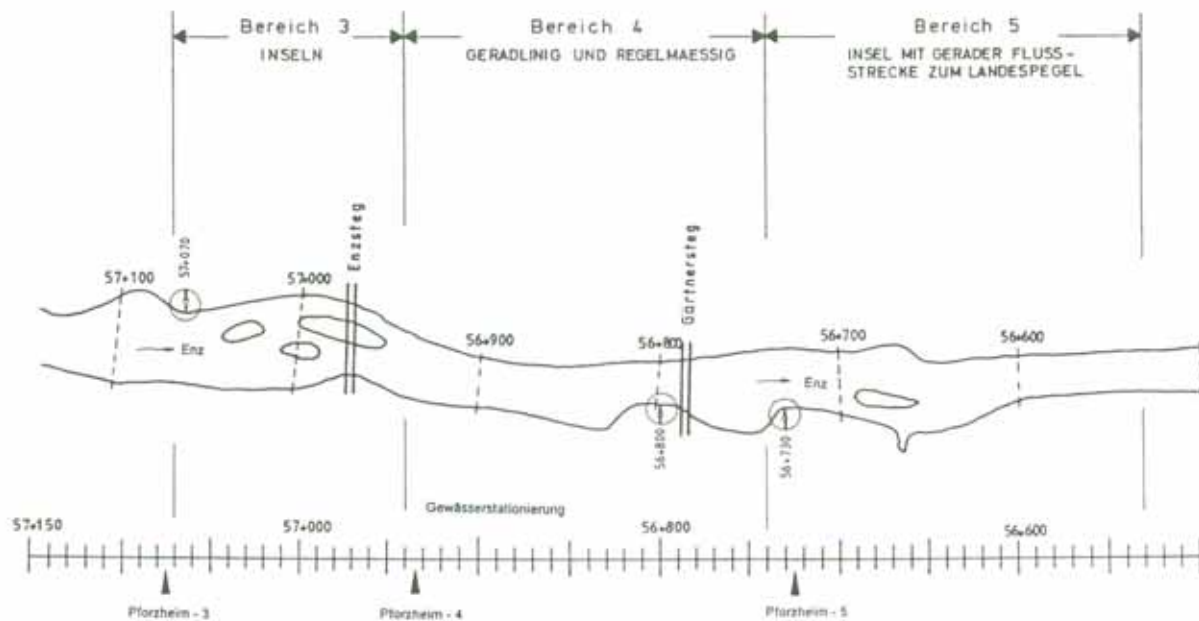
Übersichtslageplan der Umgestaltungstrecke mit den hydraulisch kritischen Punkten.
